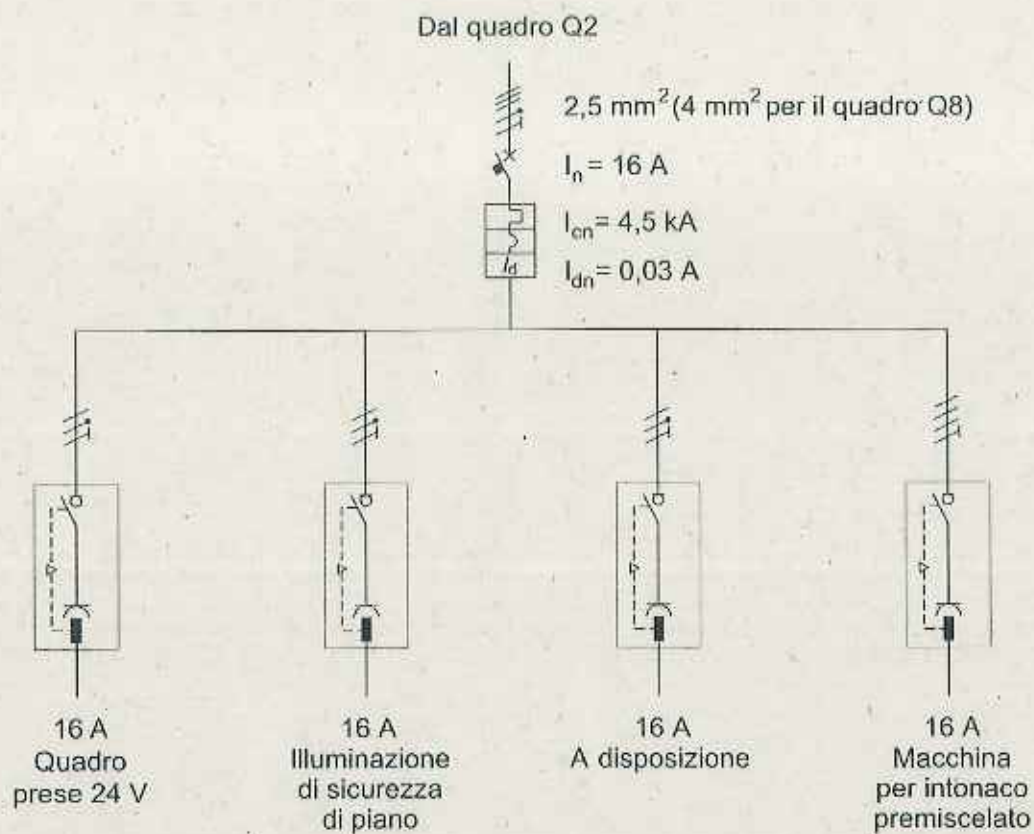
Cantiere grande (50 kW) - Schema unifilare dei quadri Q6, Q7, Q8.
